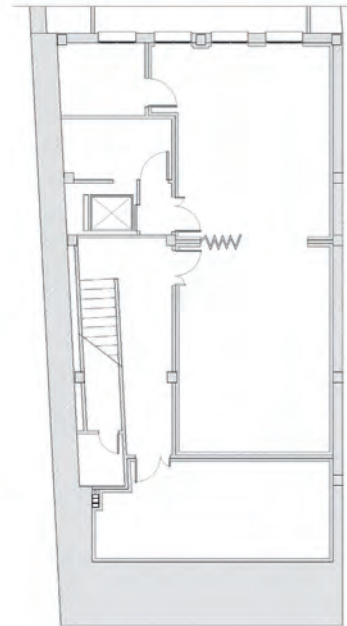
8. 1996 PLANTA SEMISÓTANO
